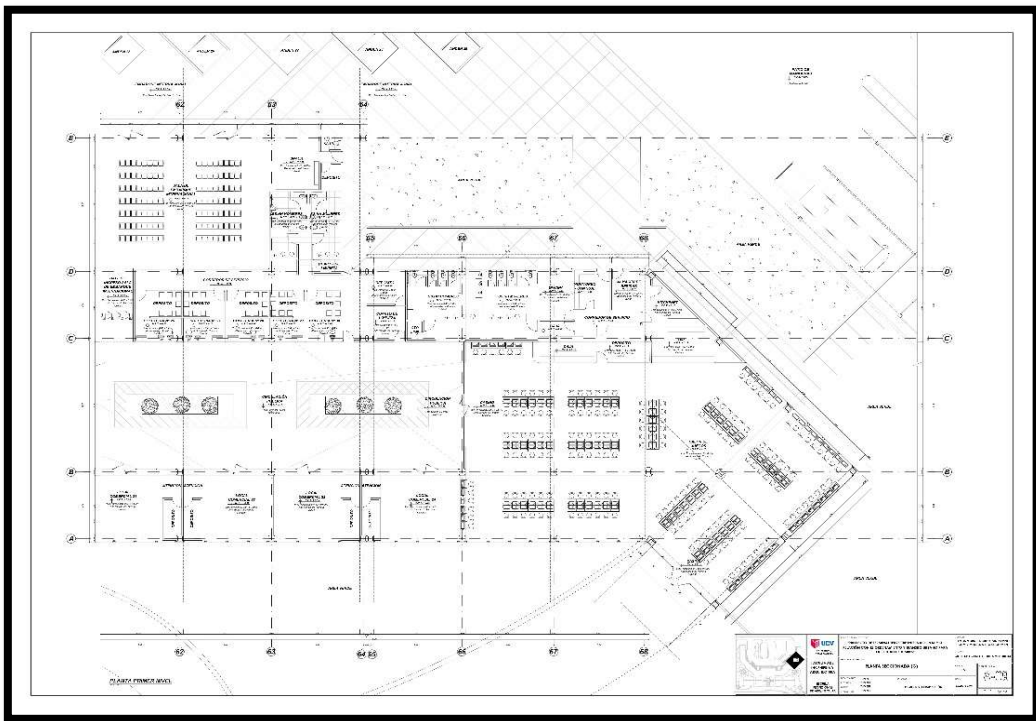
Plano Planta sector (G) Primer Nivel Fuente: Elaboración Propia.
